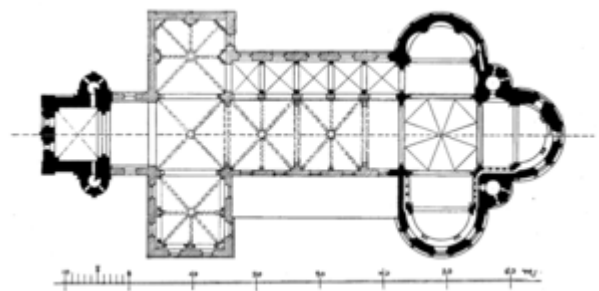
St. Apostelkirche. Grundriss.
